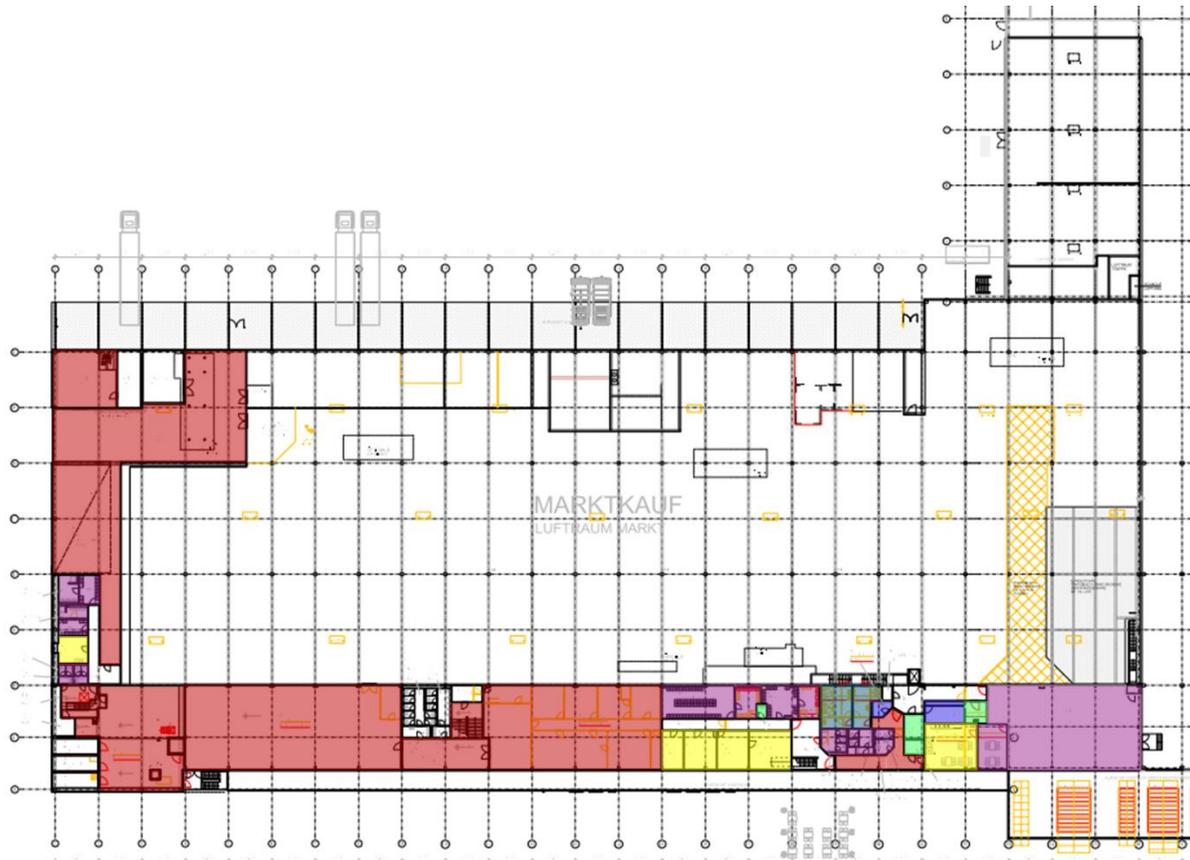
Grundriss Obergeschoss, Klimaanforderungen [2] bearbeitet
